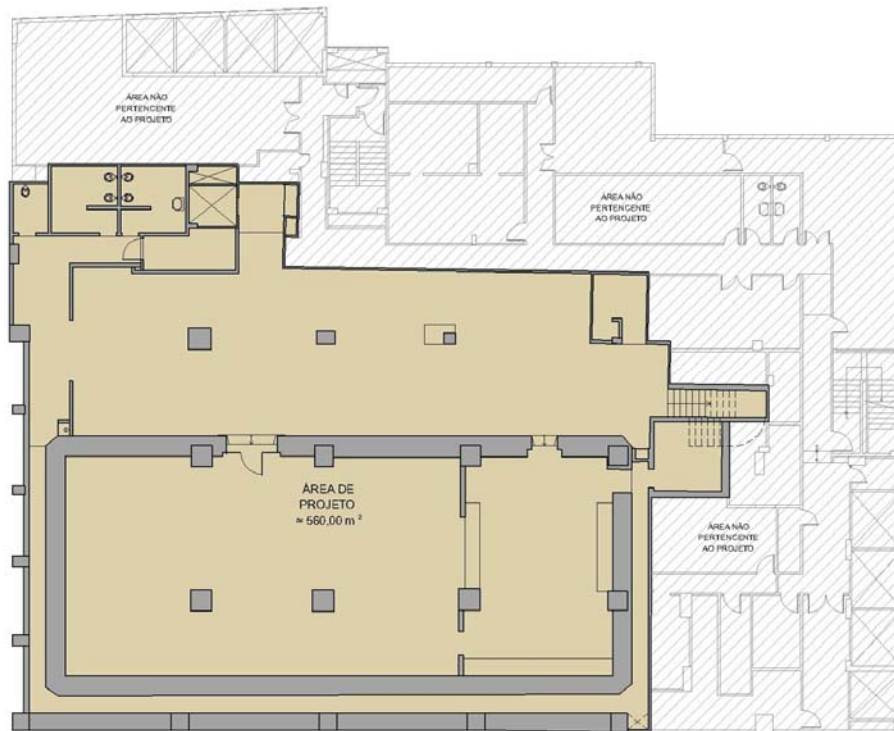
Planta baixa subsolo (limites da área de projeto)
